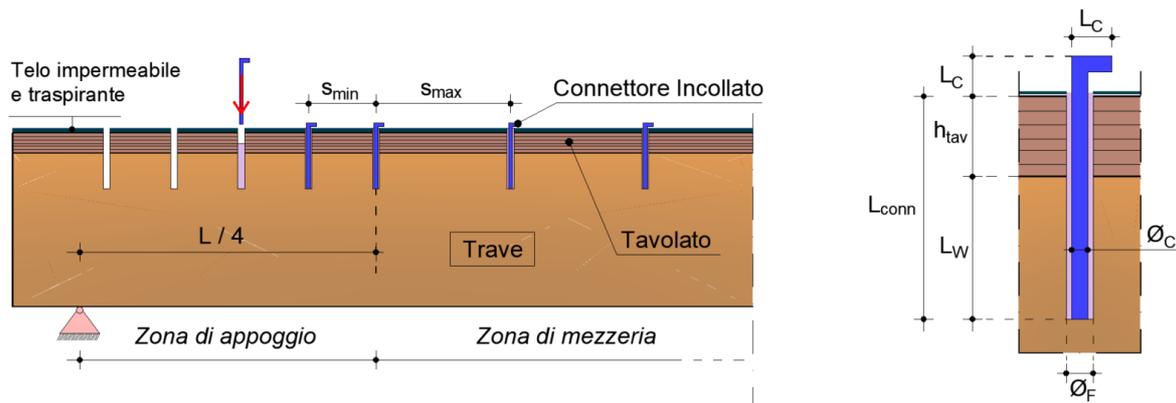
Installazione dei connettori metallici trave-soletta nel caso di solai con struttura portante in legno.
